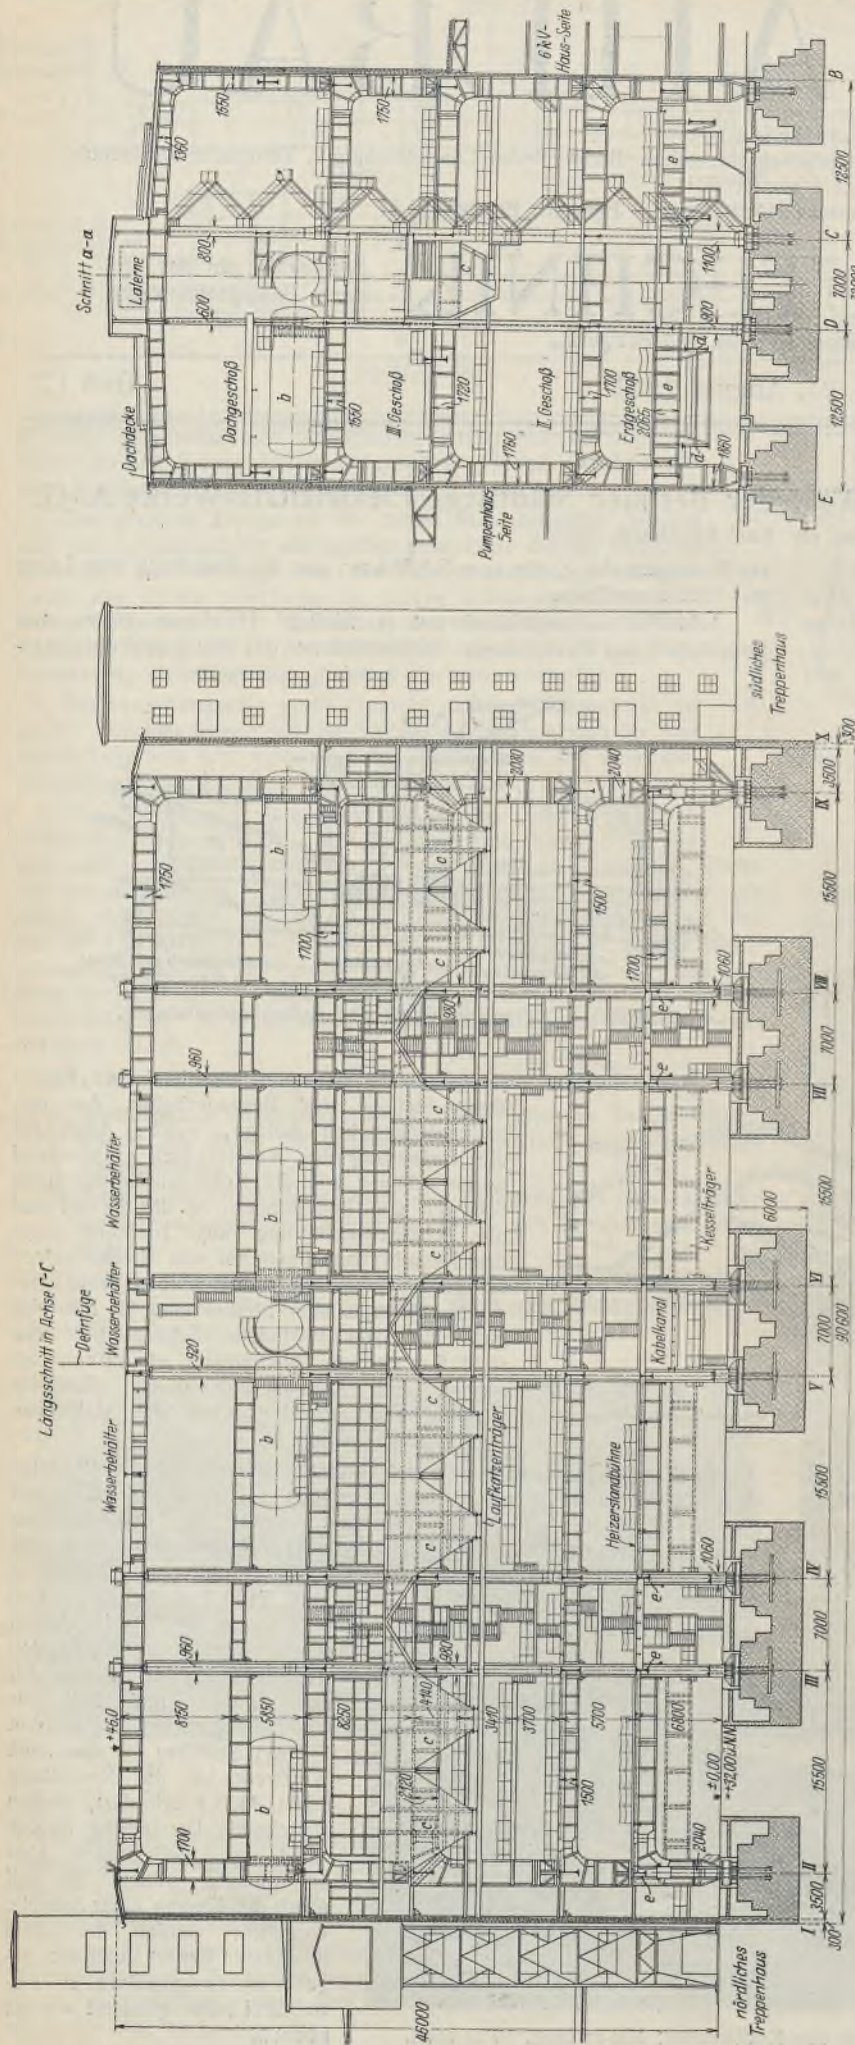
Dachgrundriß, Längs- und Querschnitt des Kesselhauses.
